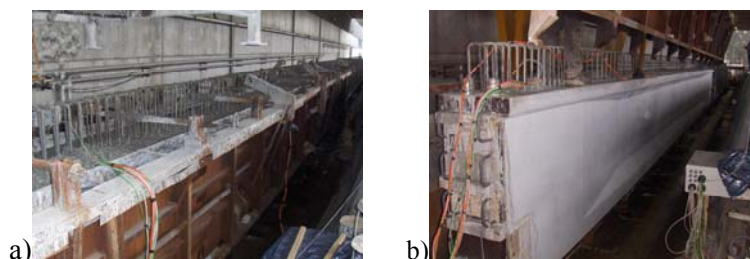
Viga instrumentada: a) instante final da betonagem; b) retirada das cofragens.
